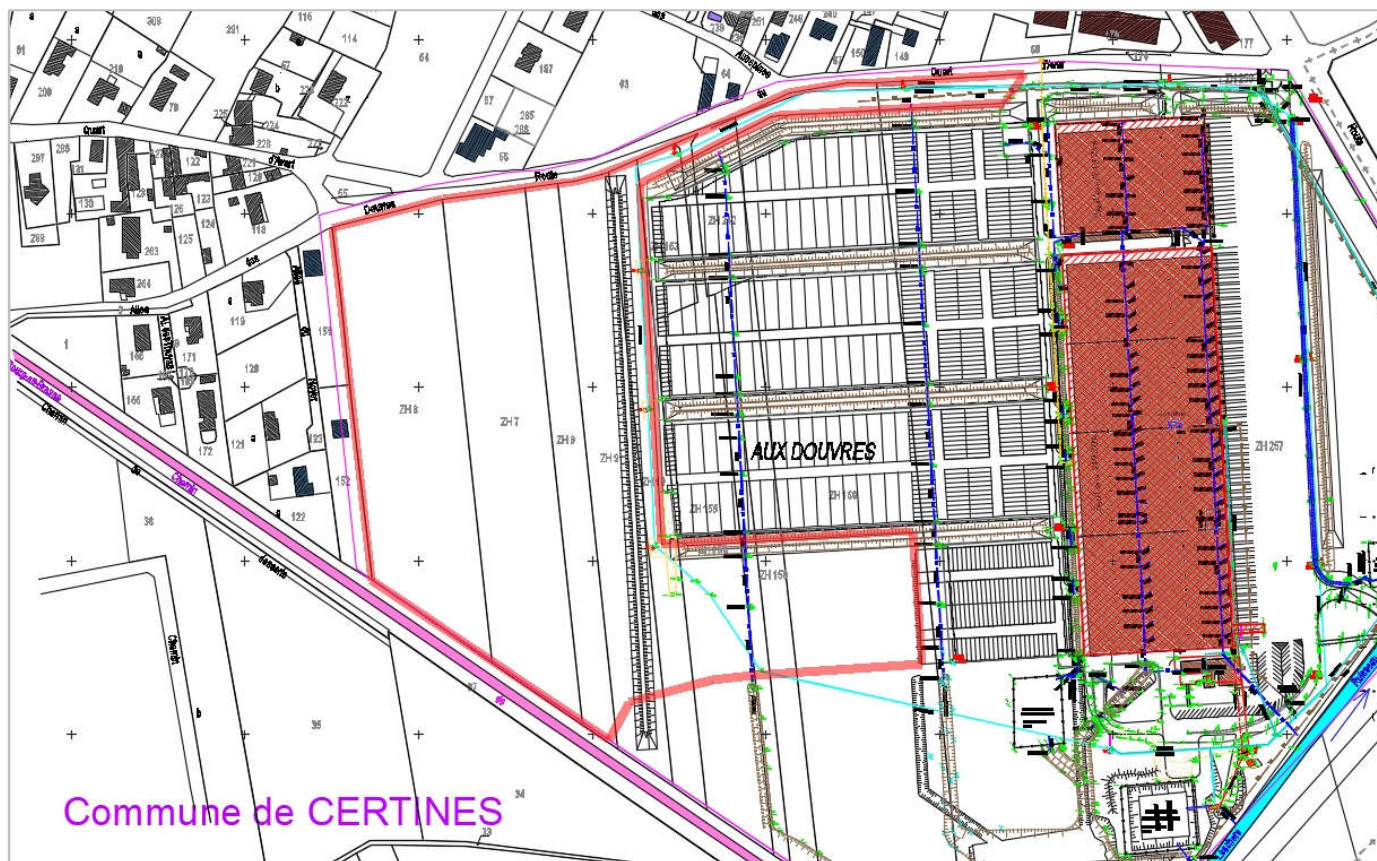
Plan de situation sur fond cadastral (emprise travaux de parkings)
